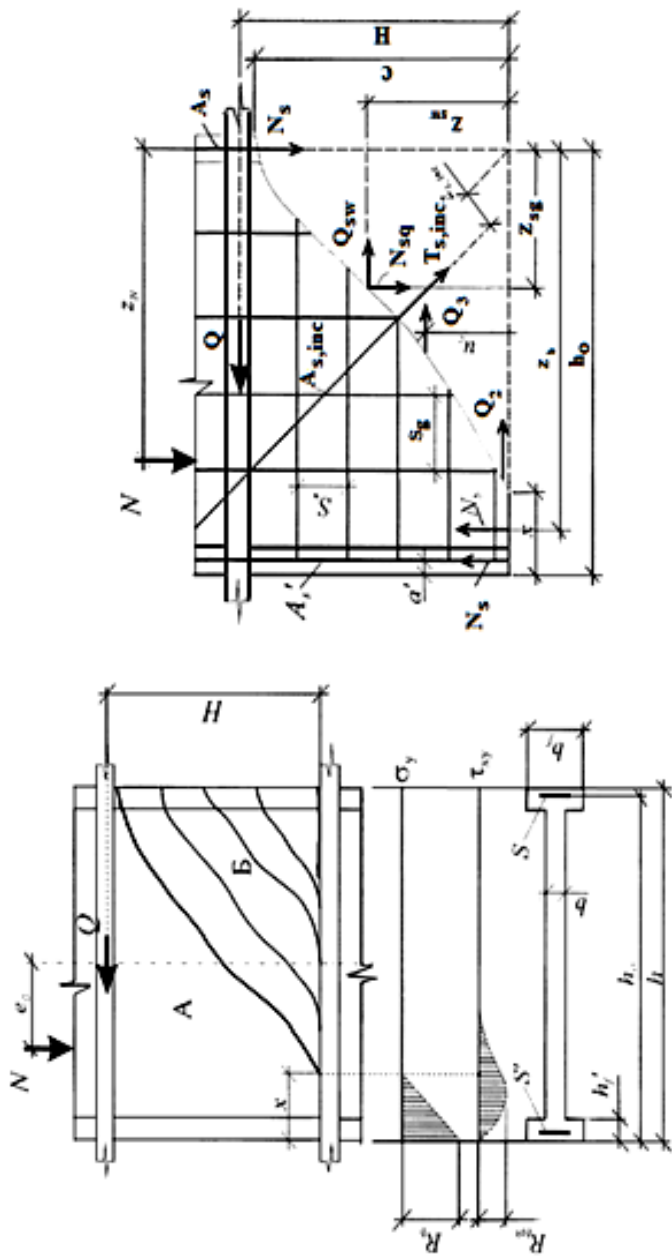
Развитие наклонных трещин в монолитной стене (а) расчетная схема усилий в наклонном сечении (б)
